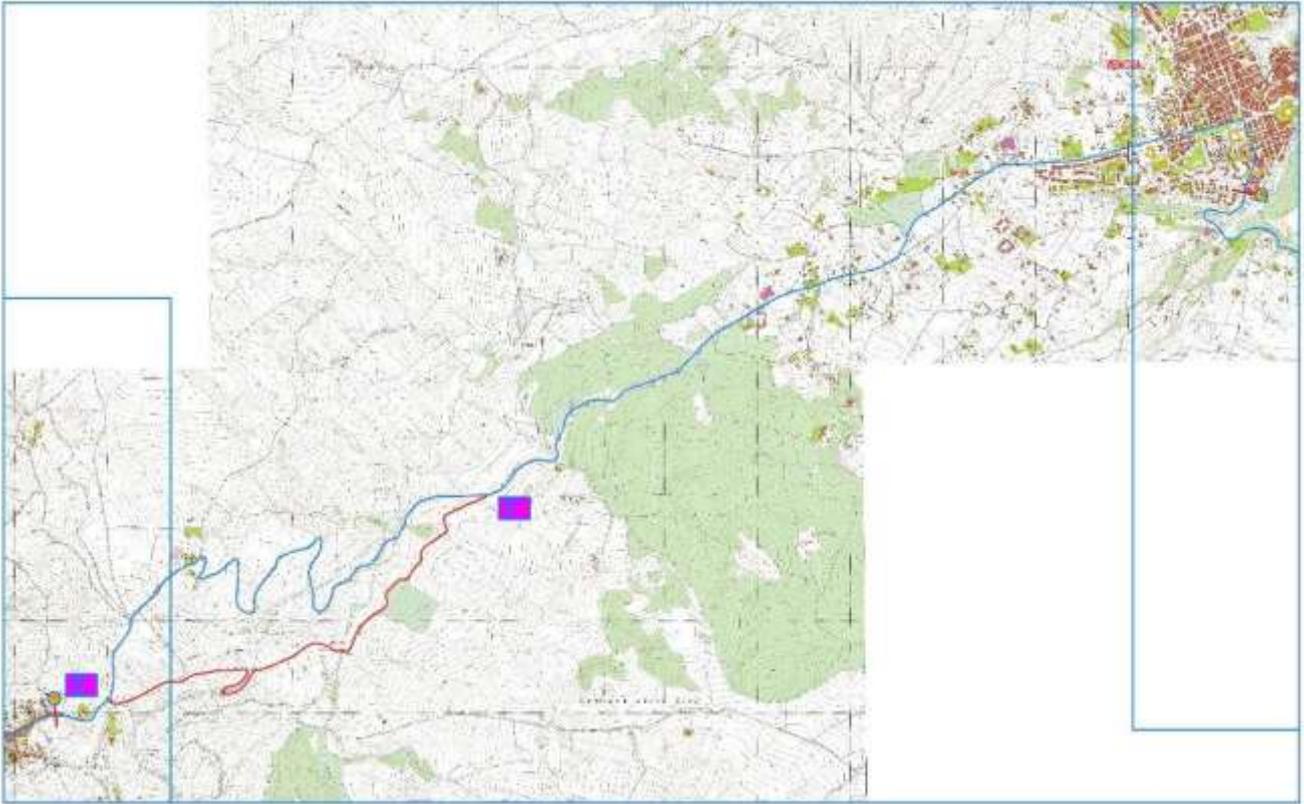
Tracciato planimetrico del Tratto 4.2 della Ciclovía.
